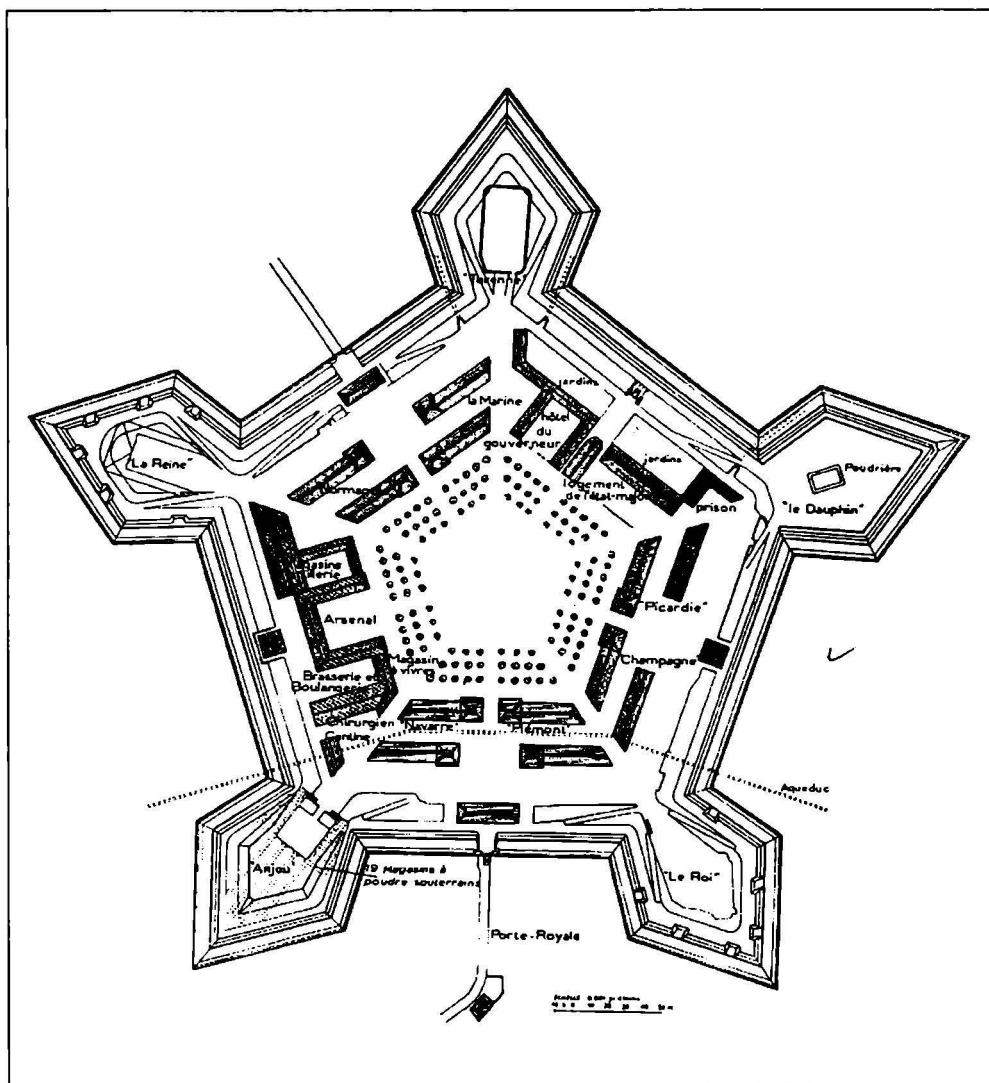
Magistrala și Instalațiile interioare ale citadelei orașului Lille, plan elaborat de Vauban în 1667 (după Colonel Rocolle).
